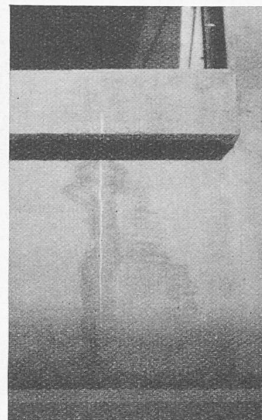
Riss in Fensterbrüstung, Auslaugung und Sinterbildung beginnt
